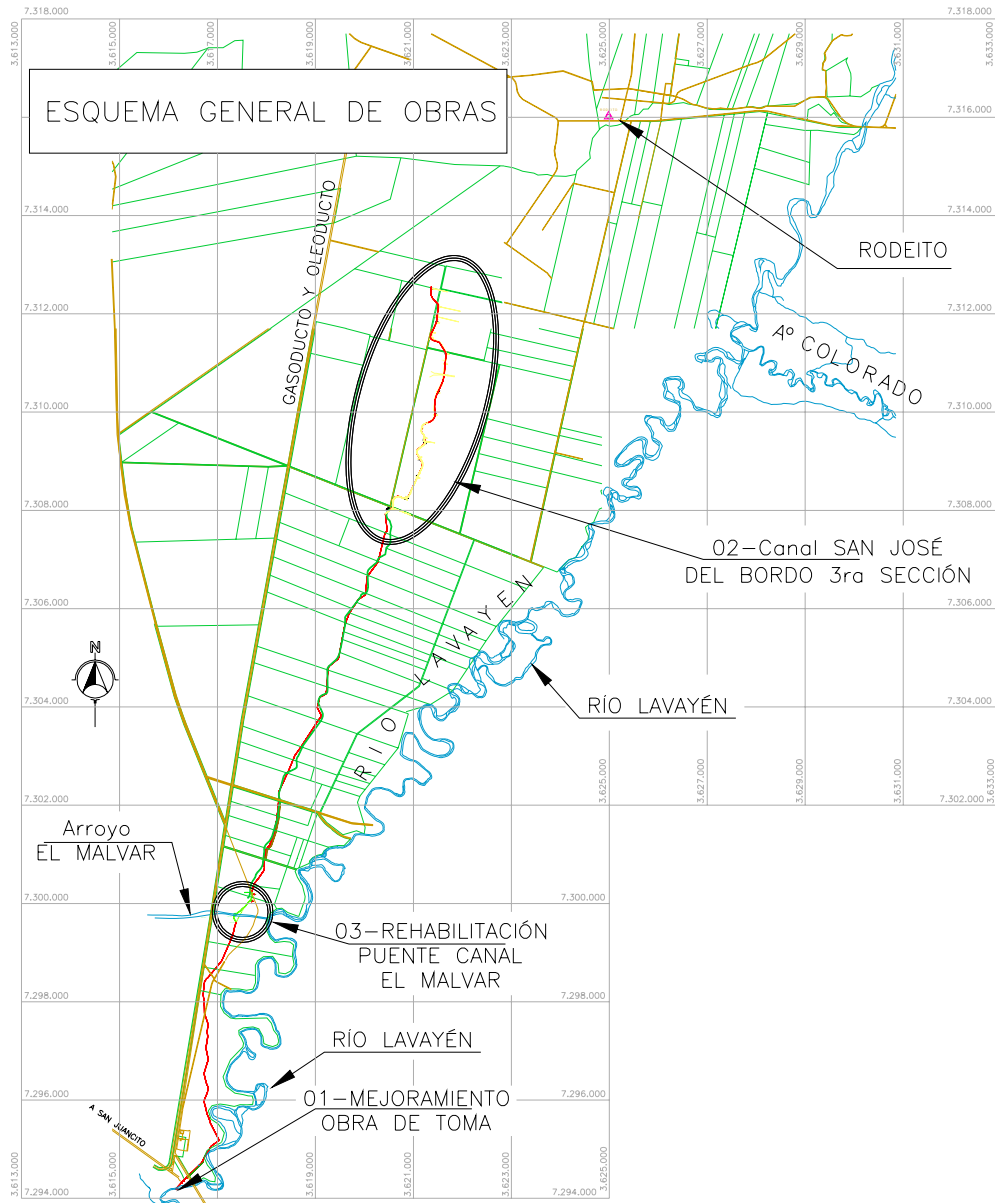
Croquis del área de proyecto con indicación de las acciones de infraestructura previstas
